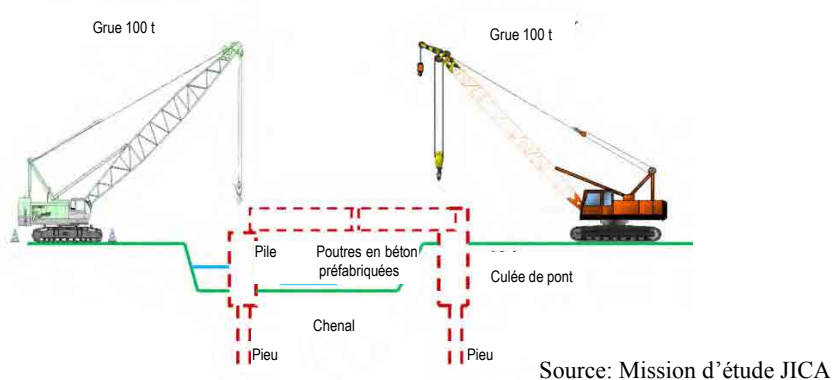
Procédé de pose des poutres en béton préfabriquées
